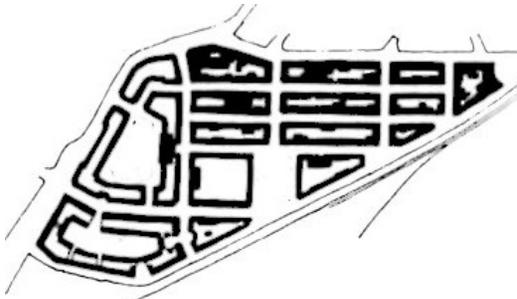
Conjunto del Barrio, Spaarndammerbuurt, Amsterdam.
